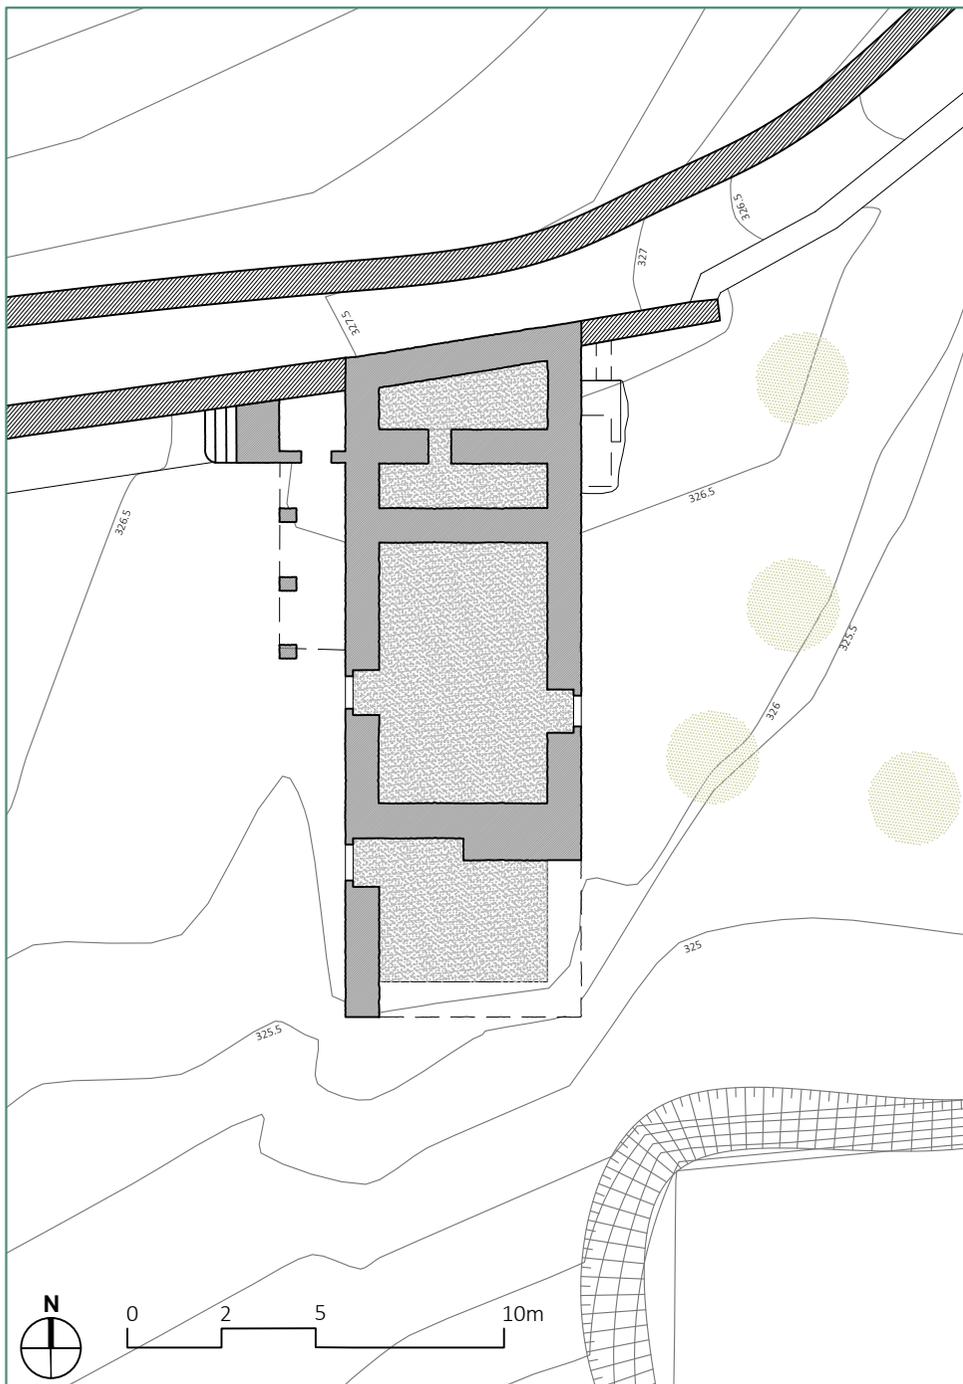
Planta baja ruinas vivienda (Elaboración propia)
